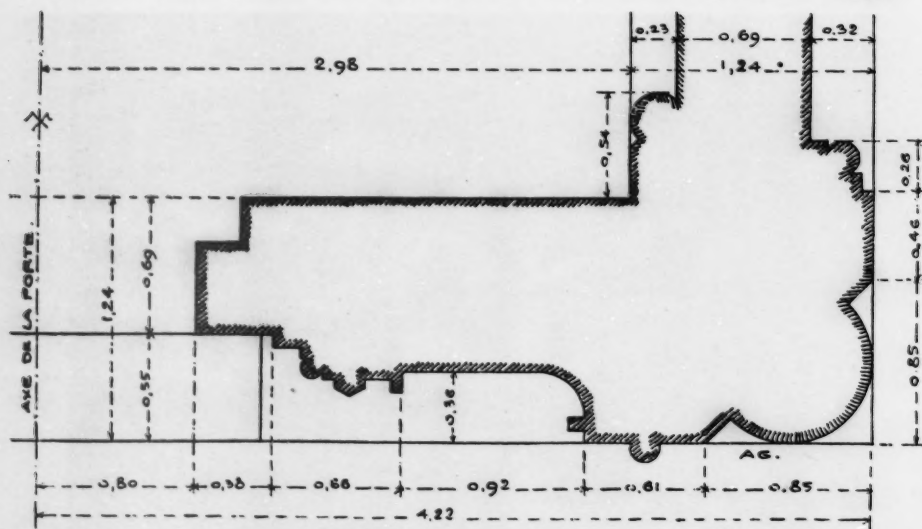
LE GUNBAD-É SURKH. DÉTAIL DU PLAN DU MUR DE FAÇADE
